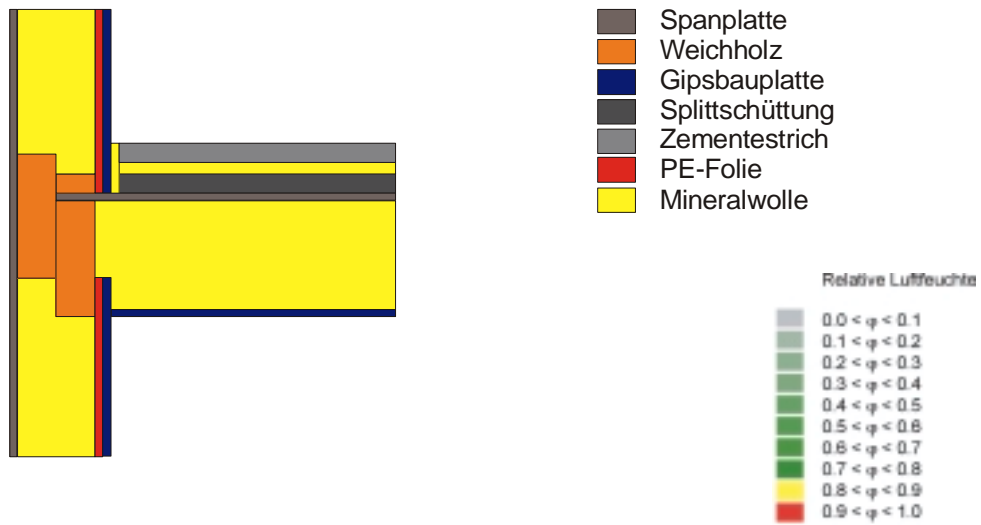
Betrachteter Schnitt durch den Wand-Deckenanschluss
